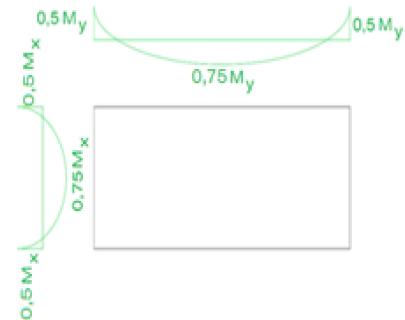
Schéma du panneau de la dalle appuyé sur 4 coté.
